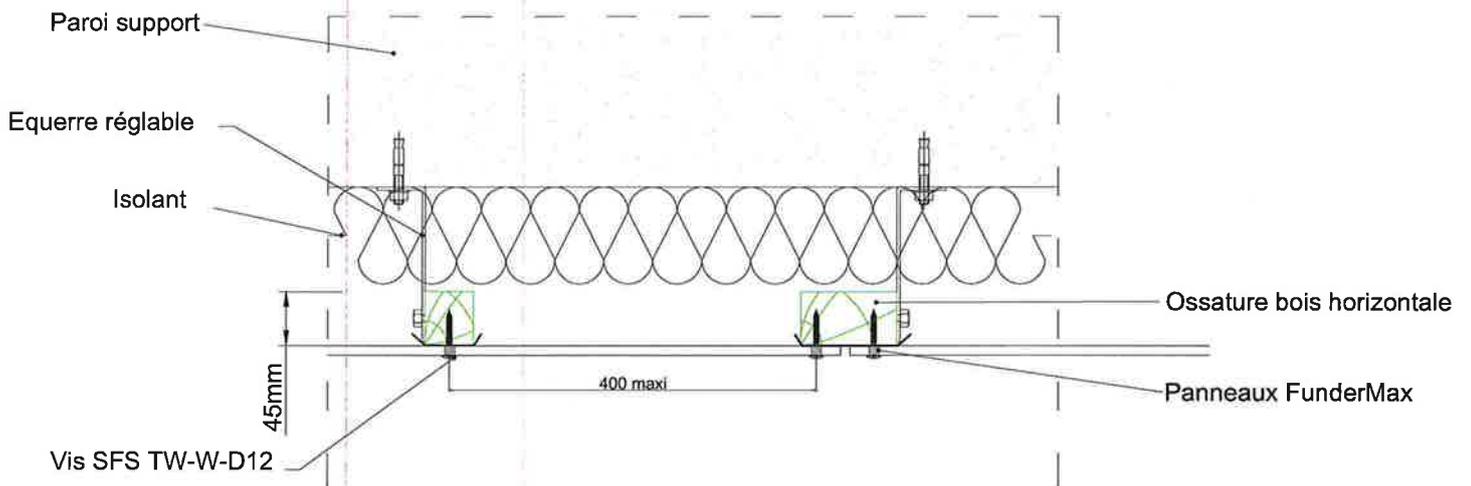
Pose en sous-face – Coupe verticale avec isolant
